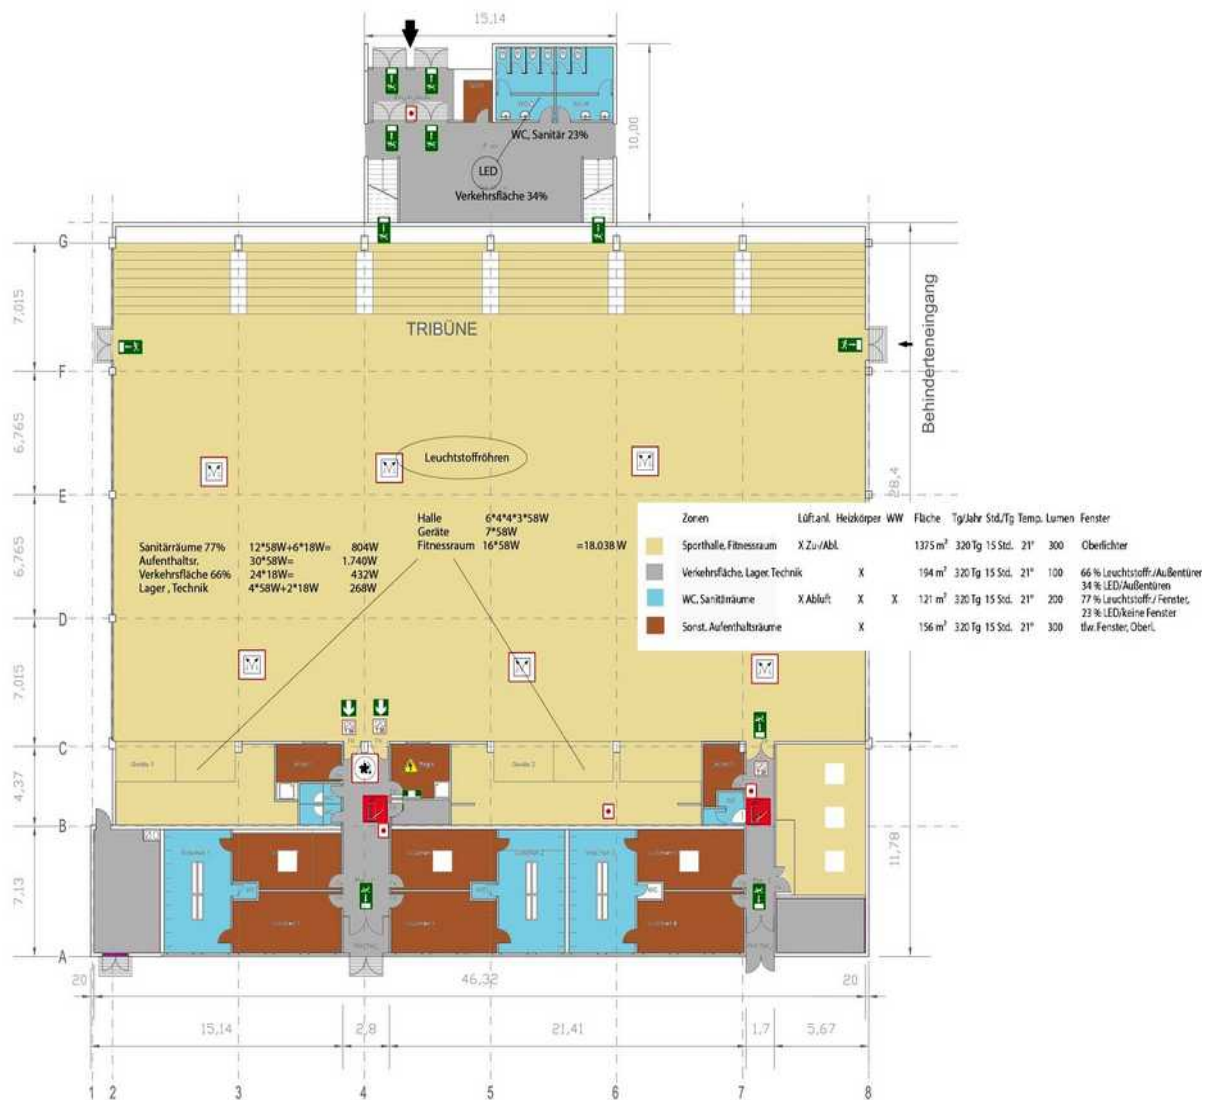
Grundriss mit den 4 Zonen
